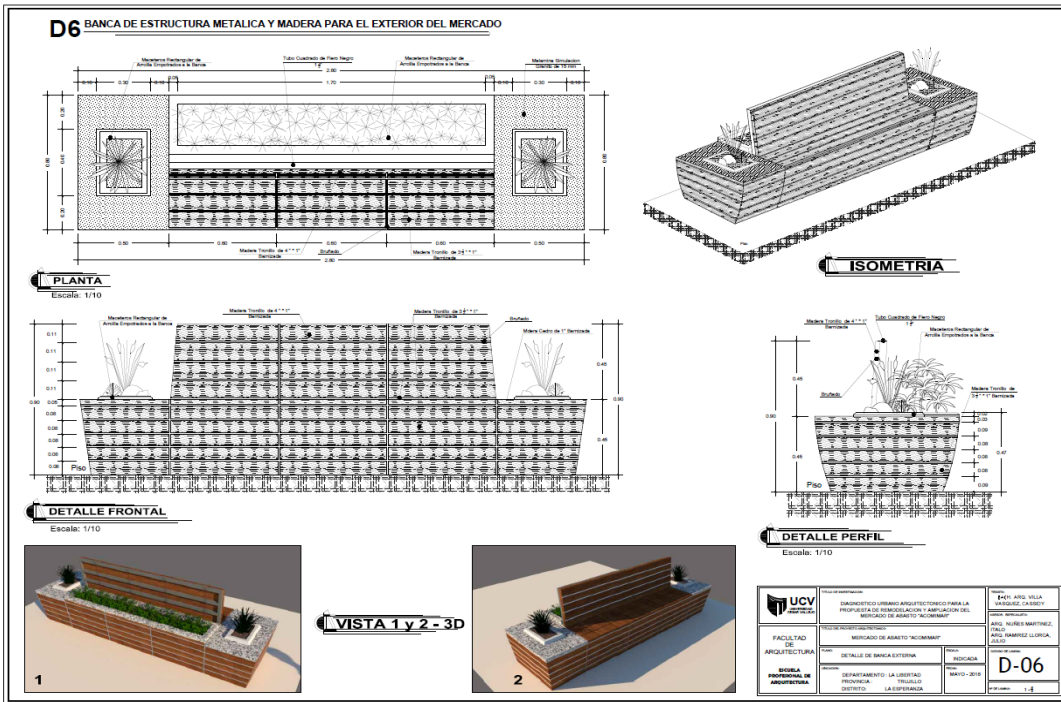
Detalle de Banca Metálica y Madera para Exterior.
